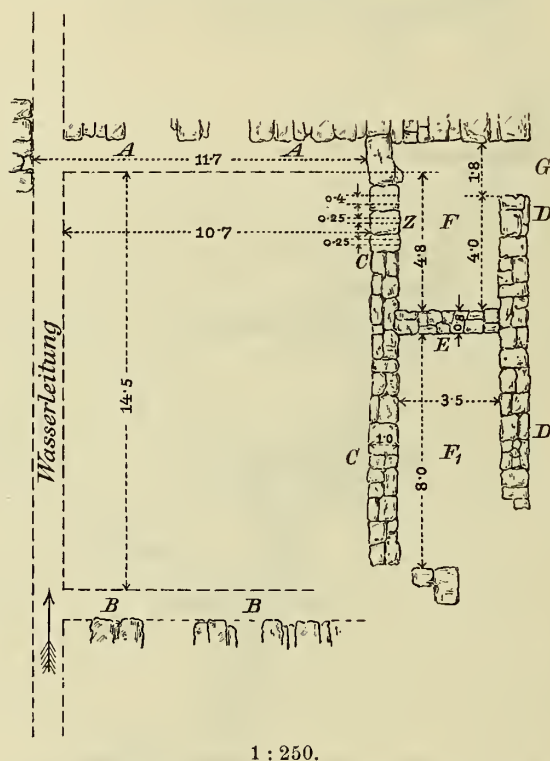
Grundriss der Mauerreste eines alten Schmelzofens in Čičevac.
